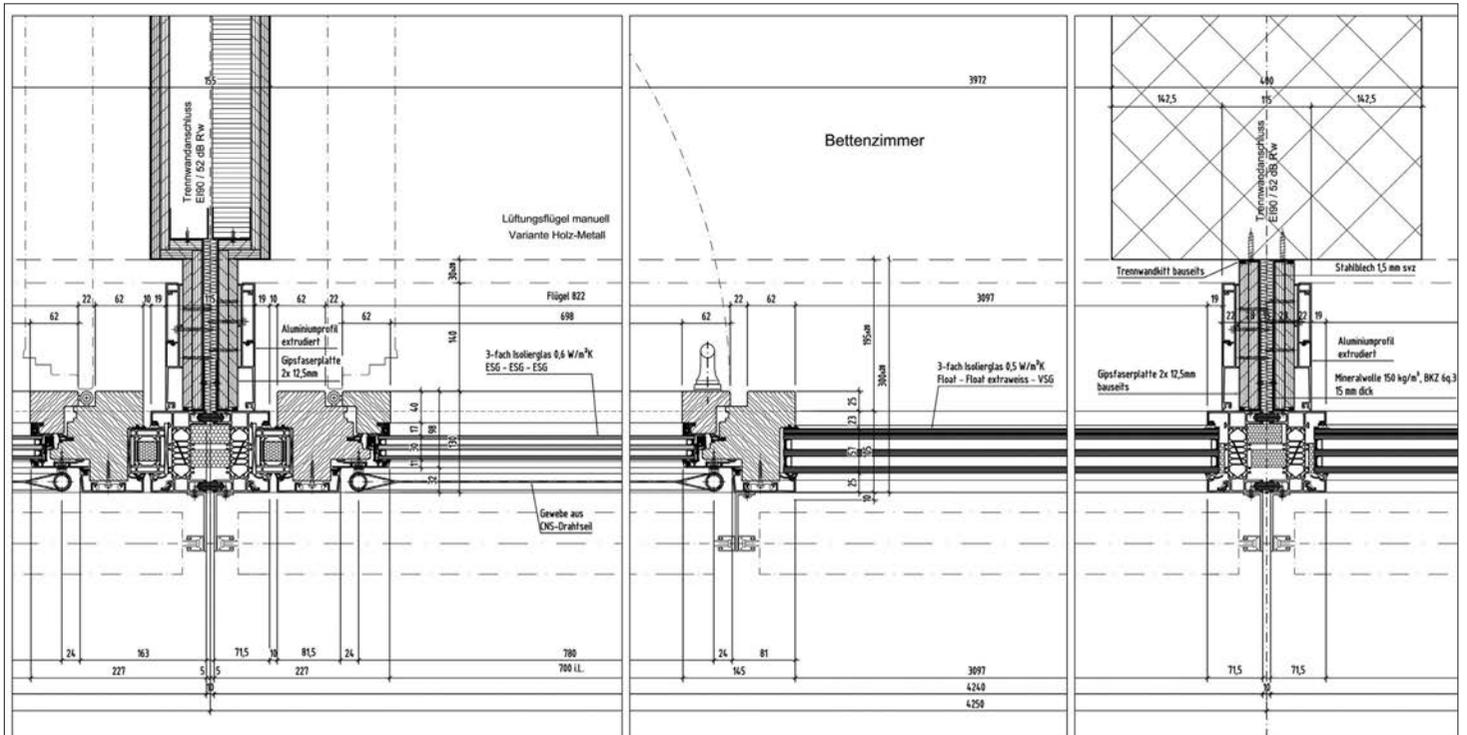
Horizontalschnitt: Fenster Betenzimmer mit dem schwimmend eingebauten Lüftungsfügel in Holz-Metall und dem aussen applizierten Gewebe aus CNS-Drahtseil, das den Zutritt zur Serviceschicht verhindert.
